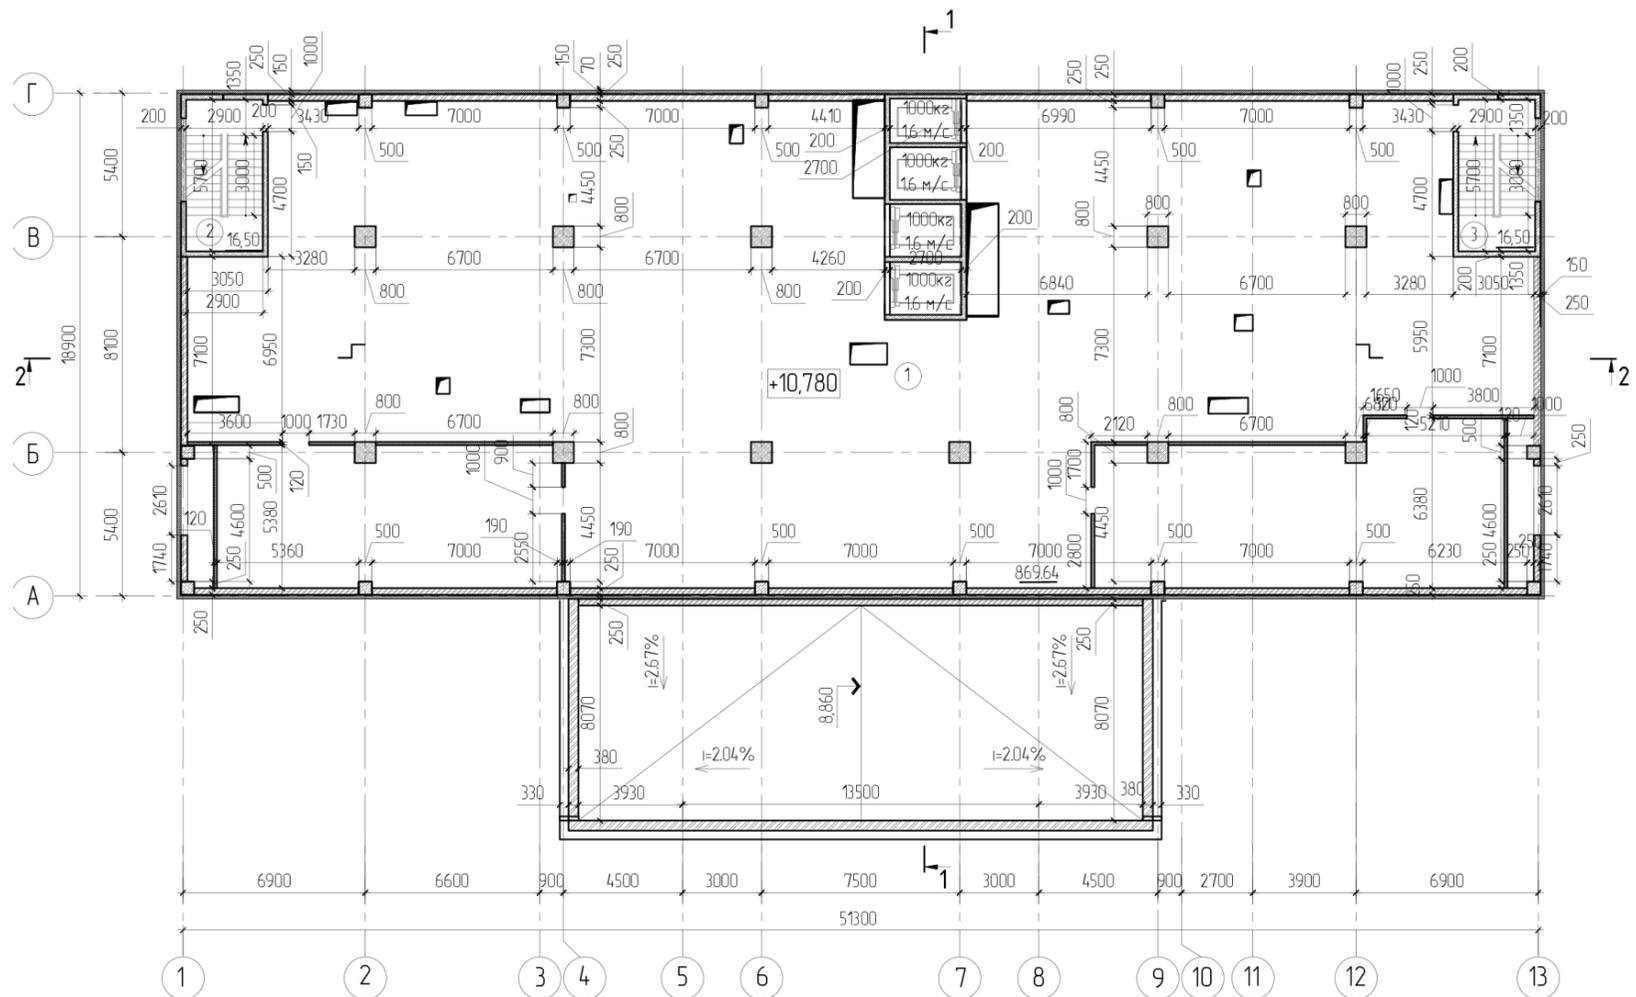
План технического этажа на отметке плюс 10.780
